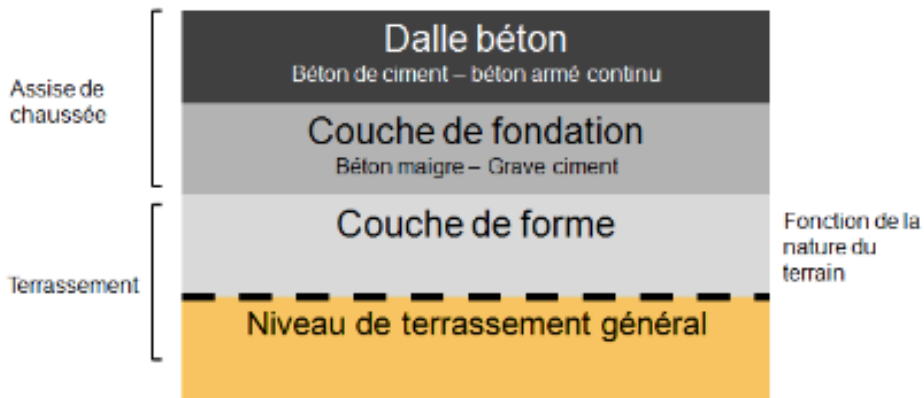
Constitution d'une chaussée en béton de ciment.
